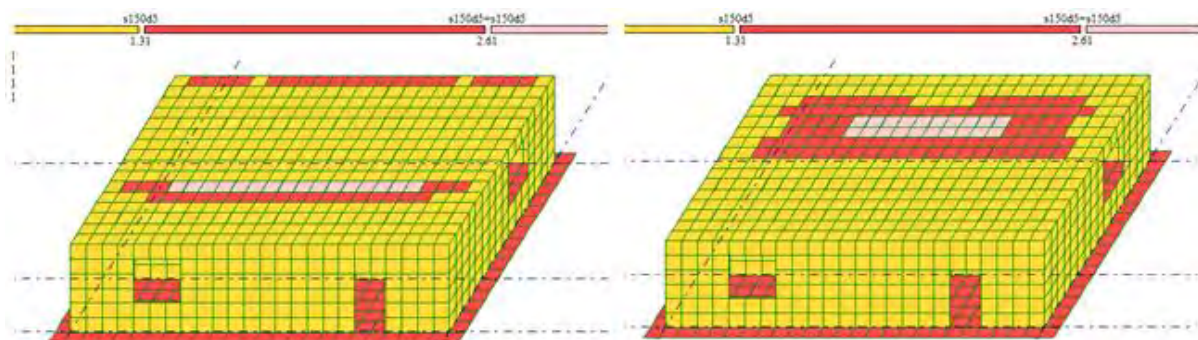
Площадь арматуры на 1 м по оси X у верхней и нижней грани
